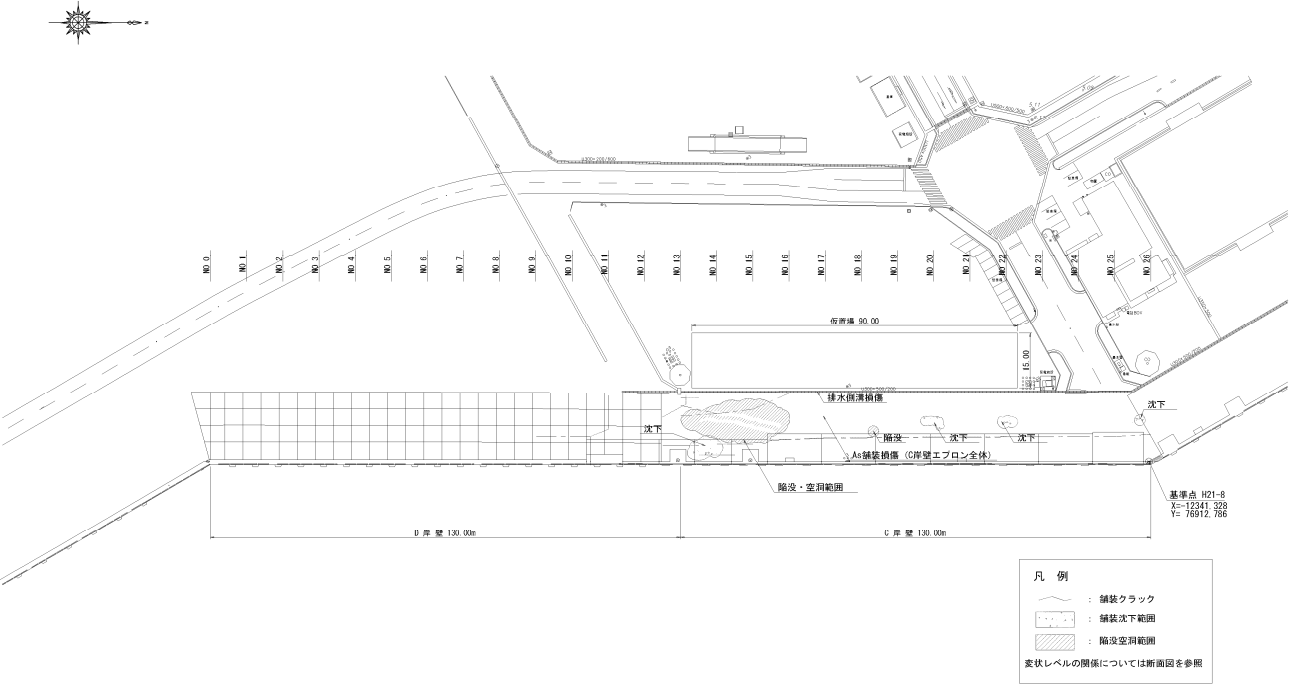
78 No. 3 鹿島港南公共ふ頭地区\_C 岸壁 (-10m) 平面図 (被災後)
